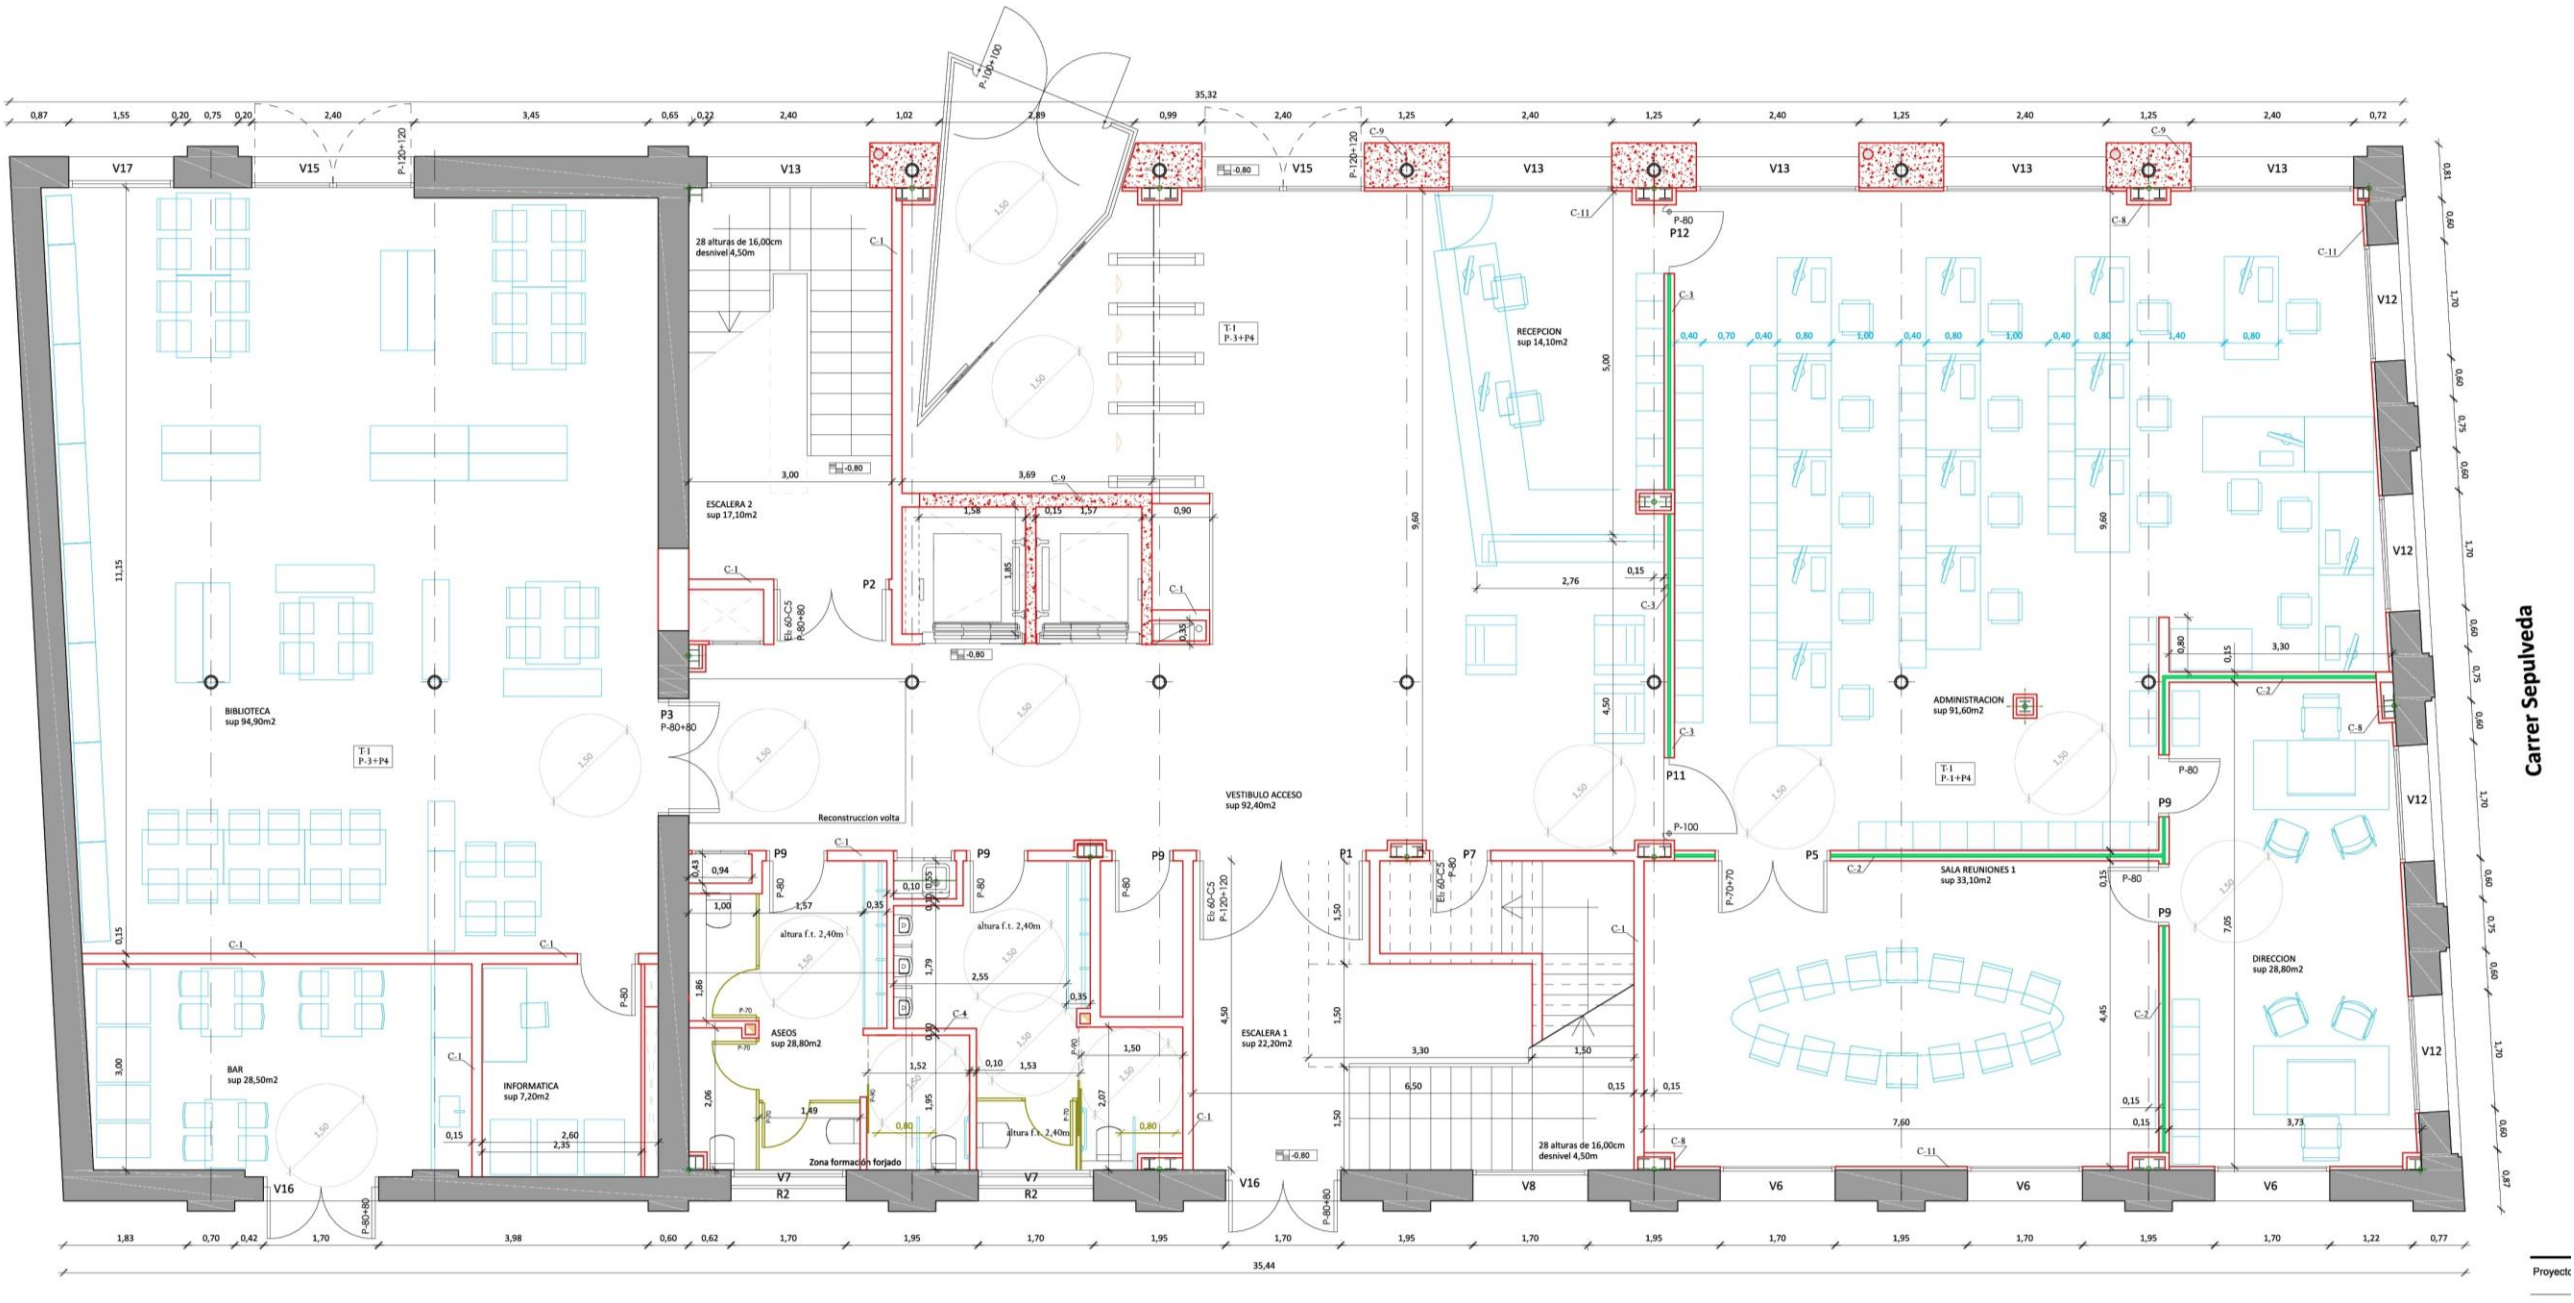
Plànol de la proposta de reforma final de la planta baixa
